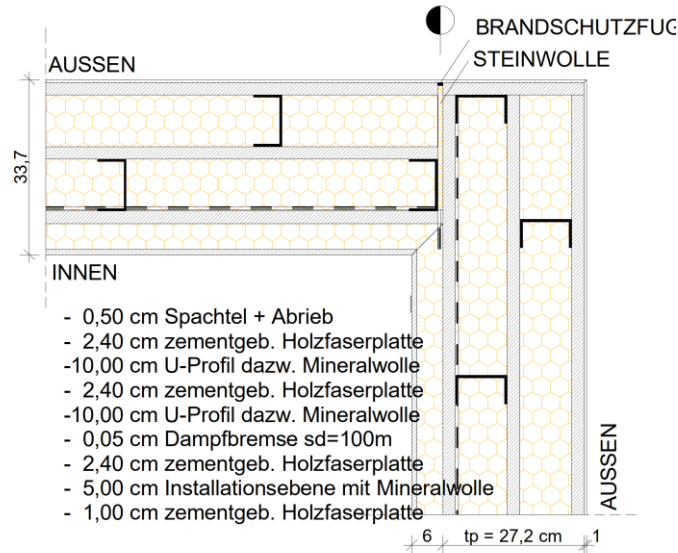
Grundriss Außenecke (Elemente gestoßen)
